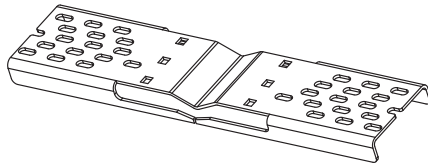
Glisser la plaque de contact arrière réglable dans la plaque dorsale pour l'aligner avec les boulons en U arrières. Ne pas serrer pour l'instant.
